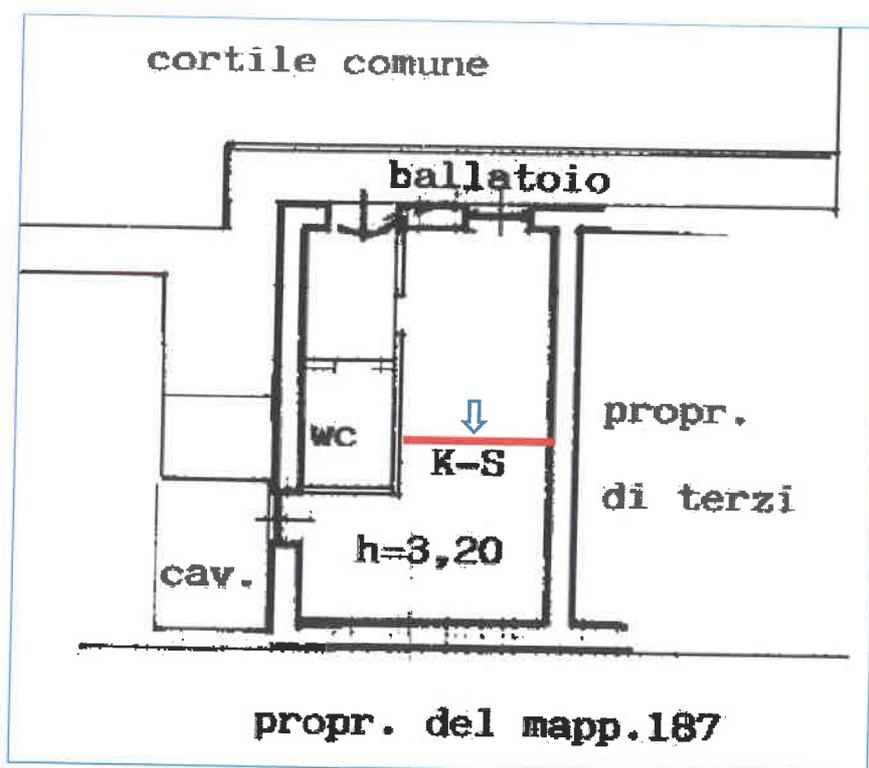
planimetria stato attuale, opere difformi da regolarizzare (rosso = parete divisoria)
